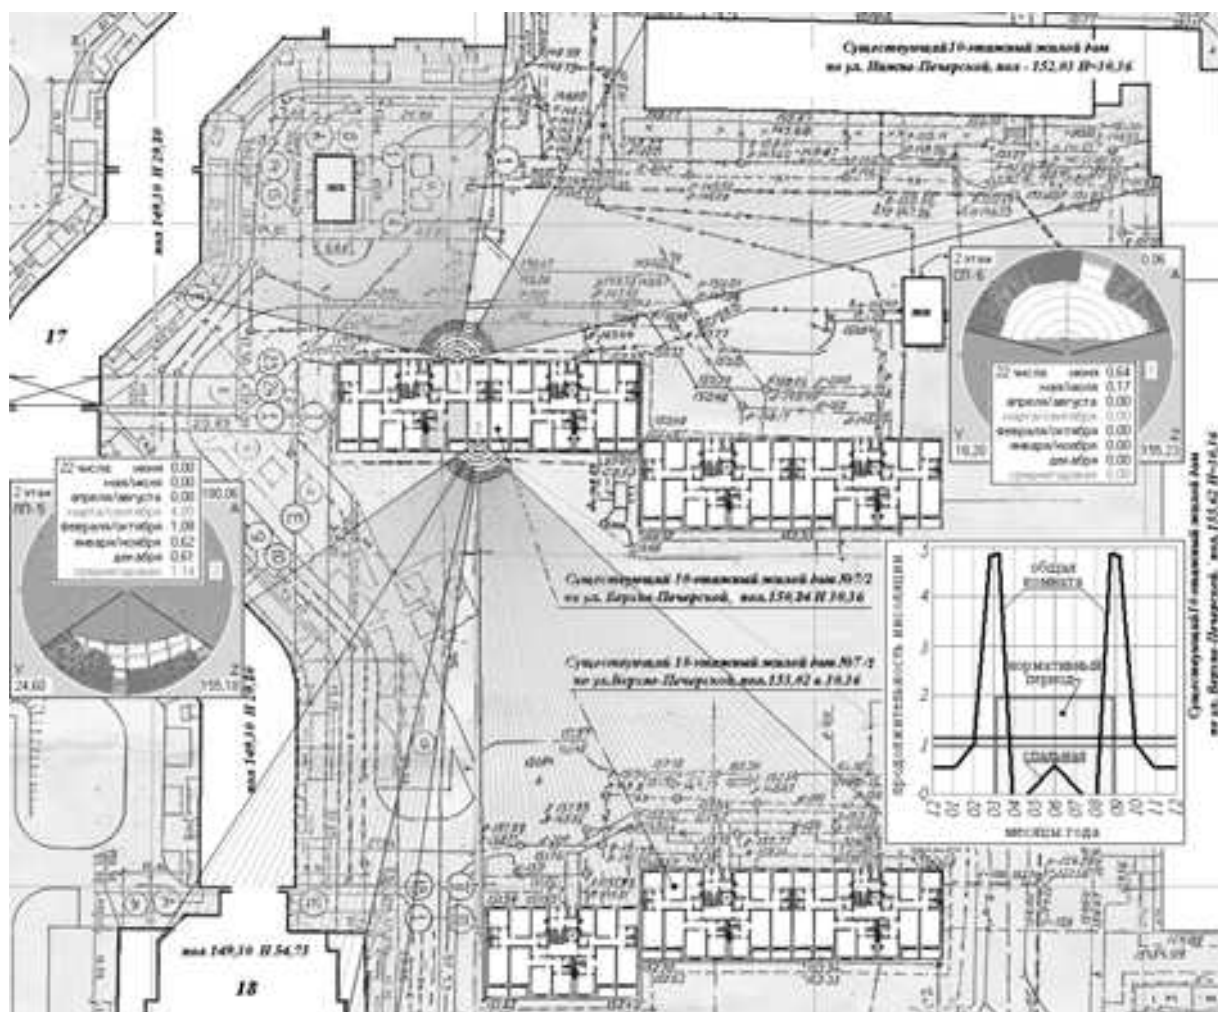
Годовой режим инсоляции трехкомнатной квартиры на втором этаже дома №7/2 по ул. Верхне-Печерской в Нижнем Новгороде
